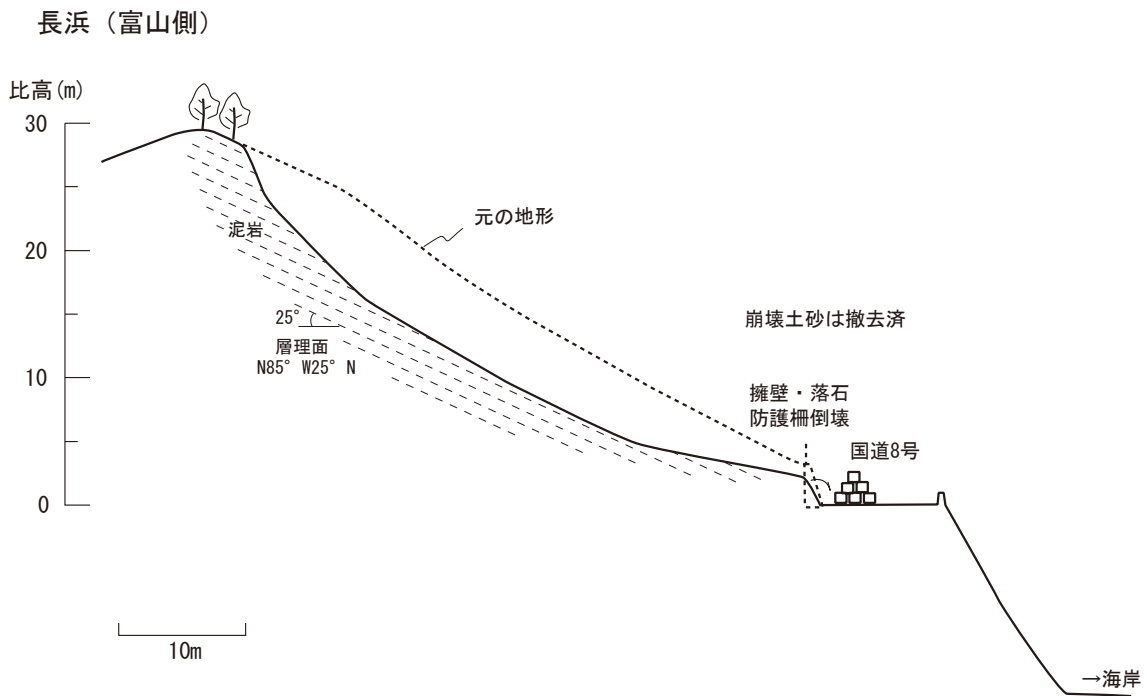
岩盤崩壊箇所（斜面 B）断面図
